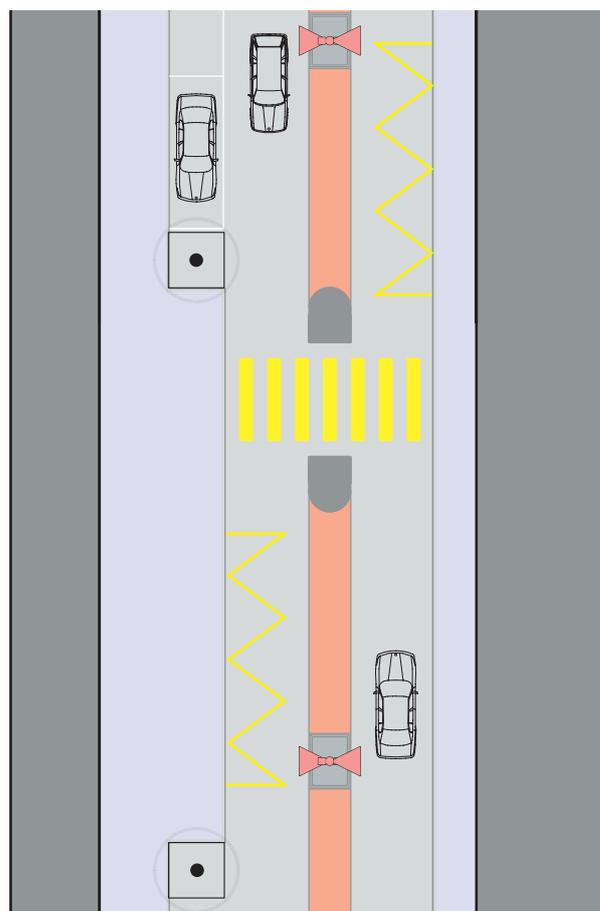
Nuova sezione stradale tipo (planimetria)
